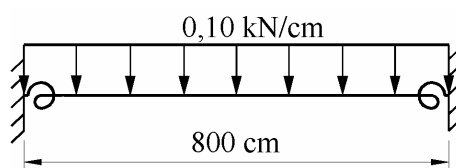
Viga submetida à carga uniformemente distribuída com ligações semirrígidas
